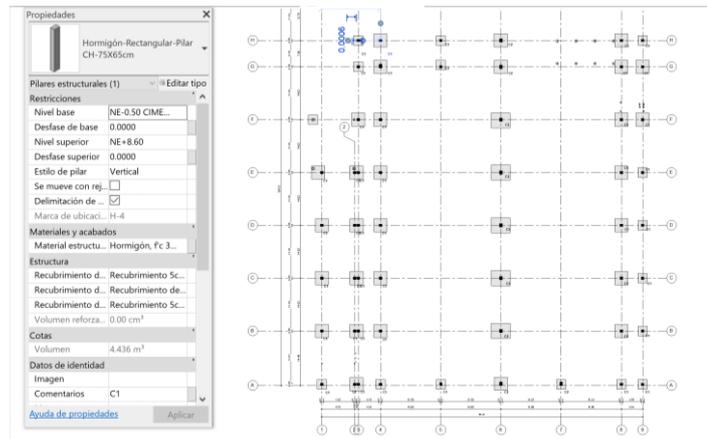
Plano con modelado de columnas, fuente Modelo estructural propia
